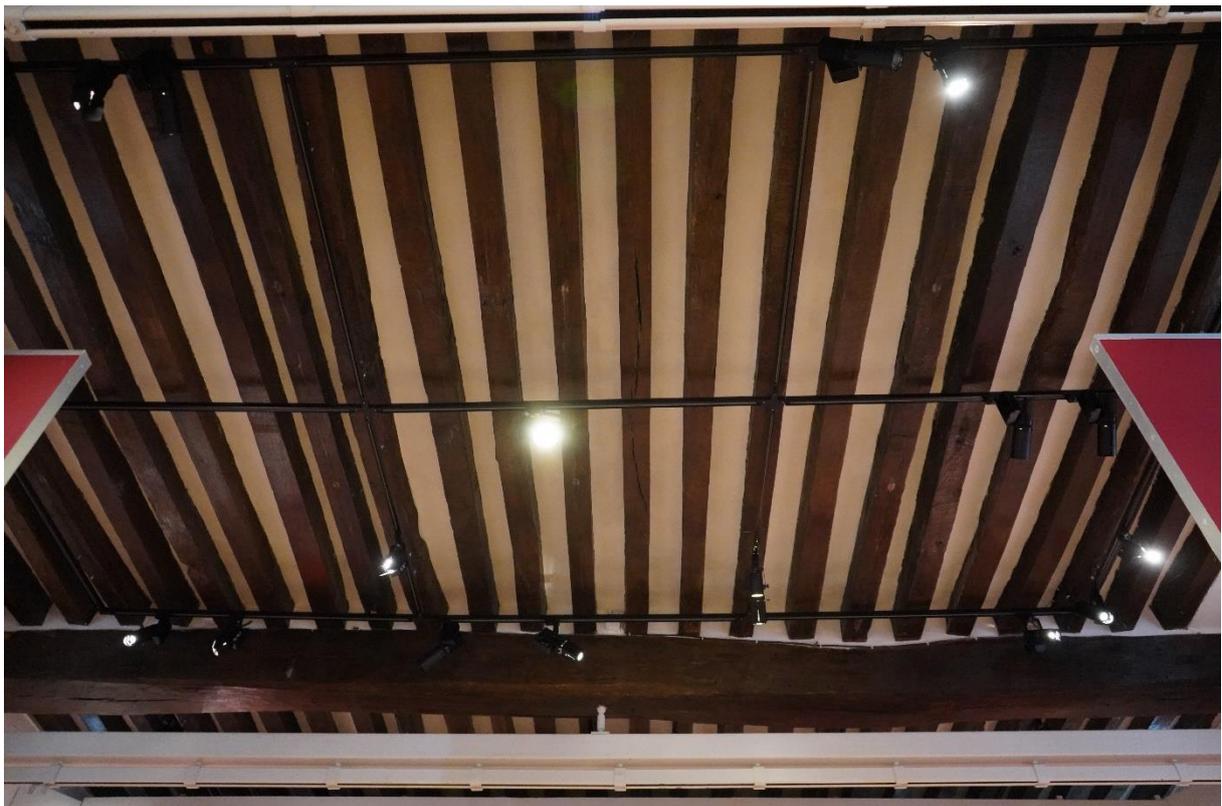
Salles 8a et 8b – Plafond
